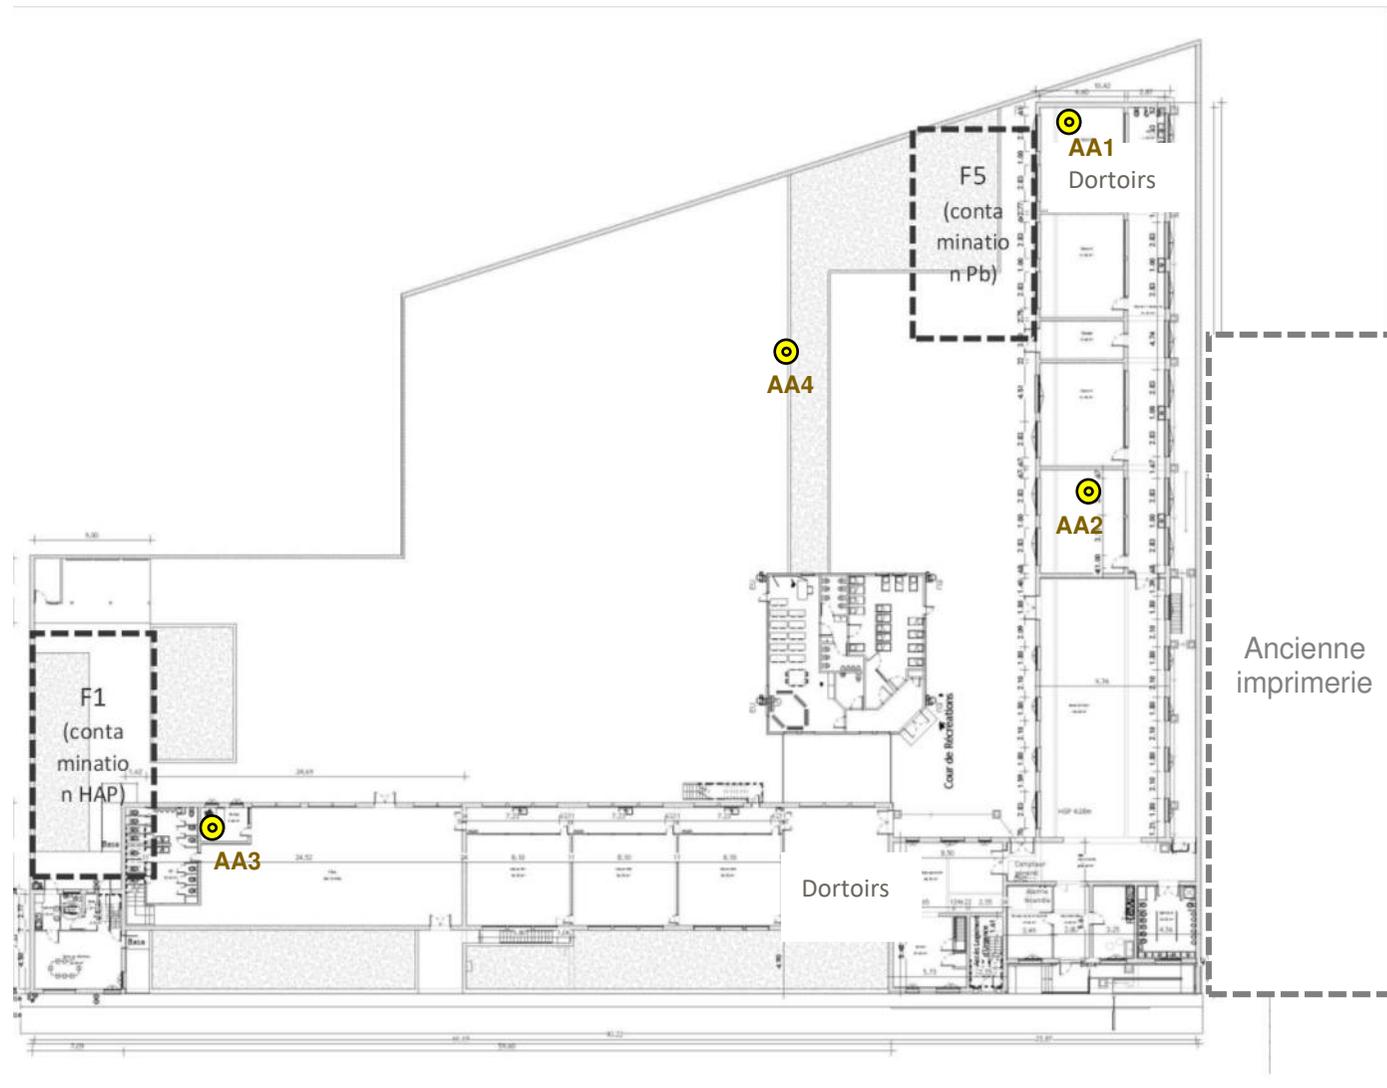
plan de localisation des prélèvements (fond de vue : plan école du client)
